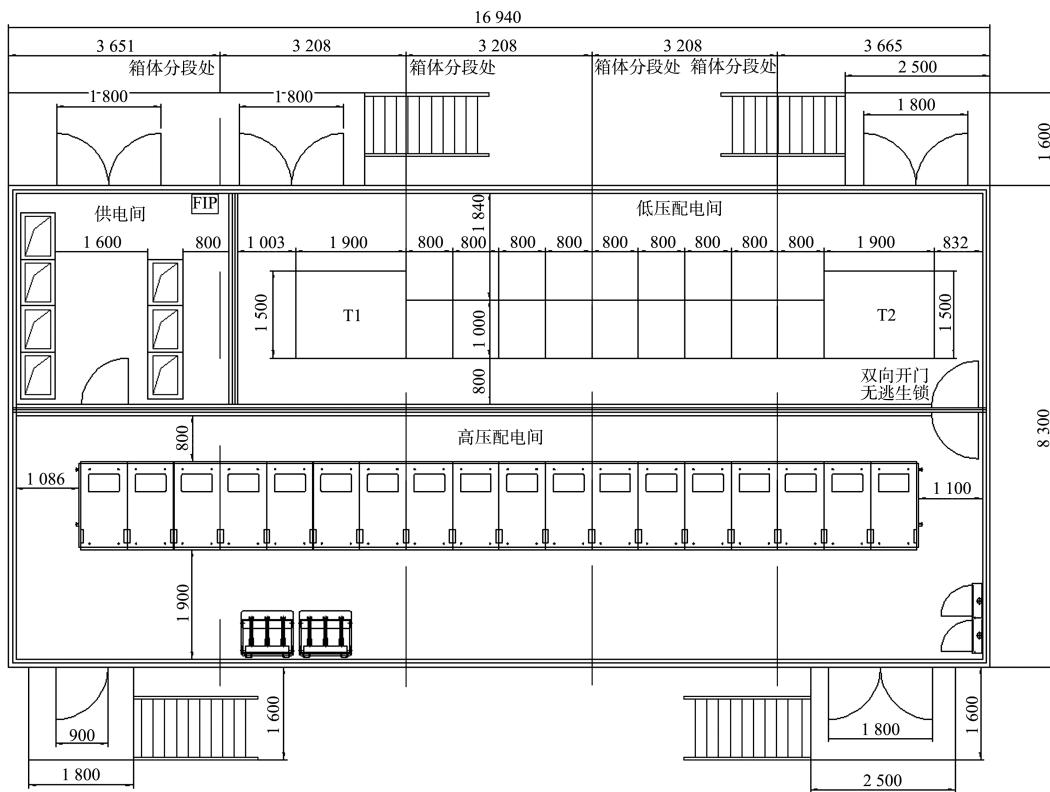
印尼OBI项目E-house工艺平面布置(单位:mm)
